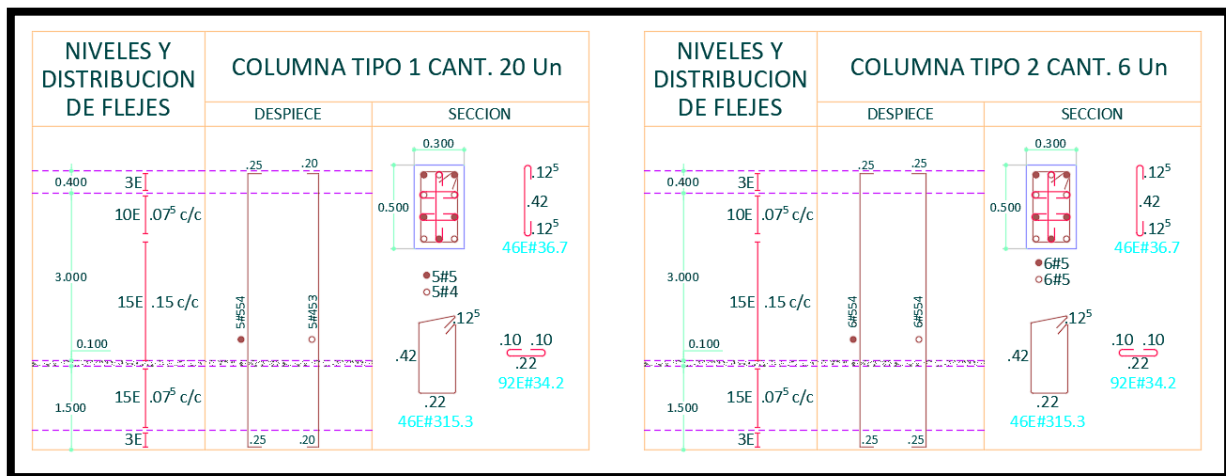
Despiece de acero de las columnas. Fuente: Propia.
